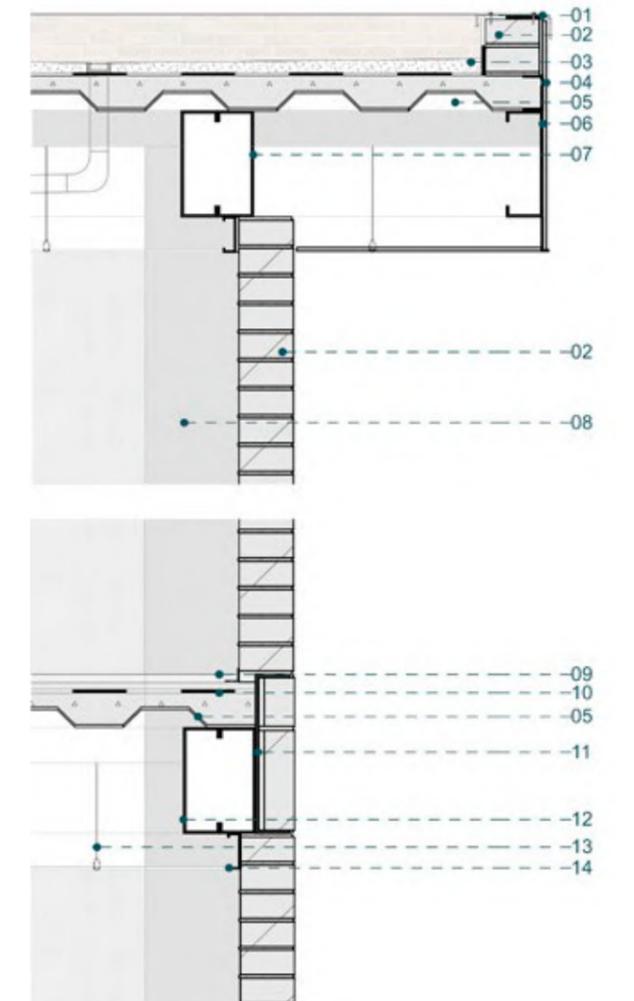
| Elevación, sección y detalles aulario colegio | Fuente: Elaboración Propia
